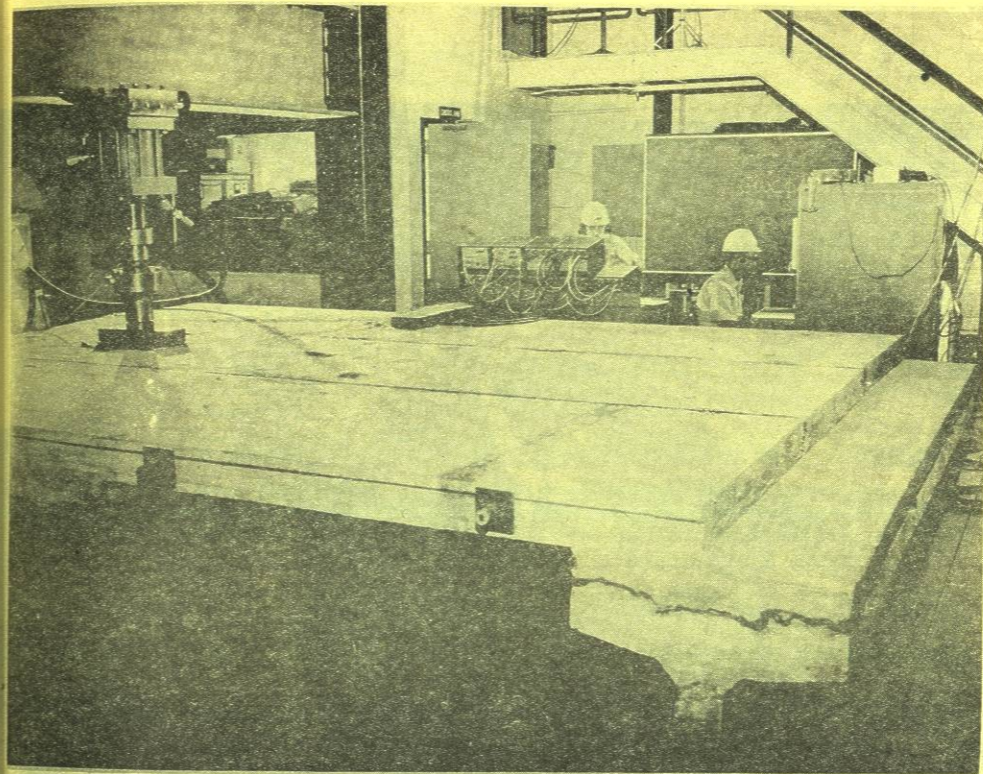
Arreglo para el ensaye de 3 paneles impregnados con polímero para losa de puente.
